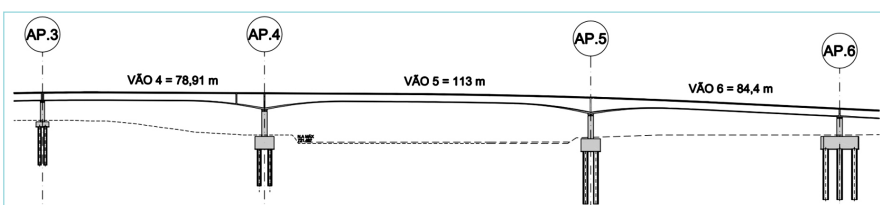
ELEVAÇÃO – VÃO CENTRAL E ADJACENTES
